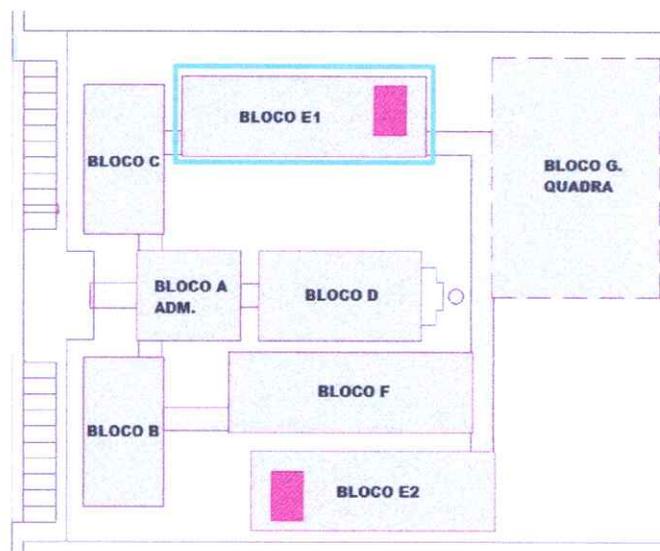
Layout dos Blocos, conforme Projeto de Arquitetura. Fonte: Projeto Padrão FNDE.
